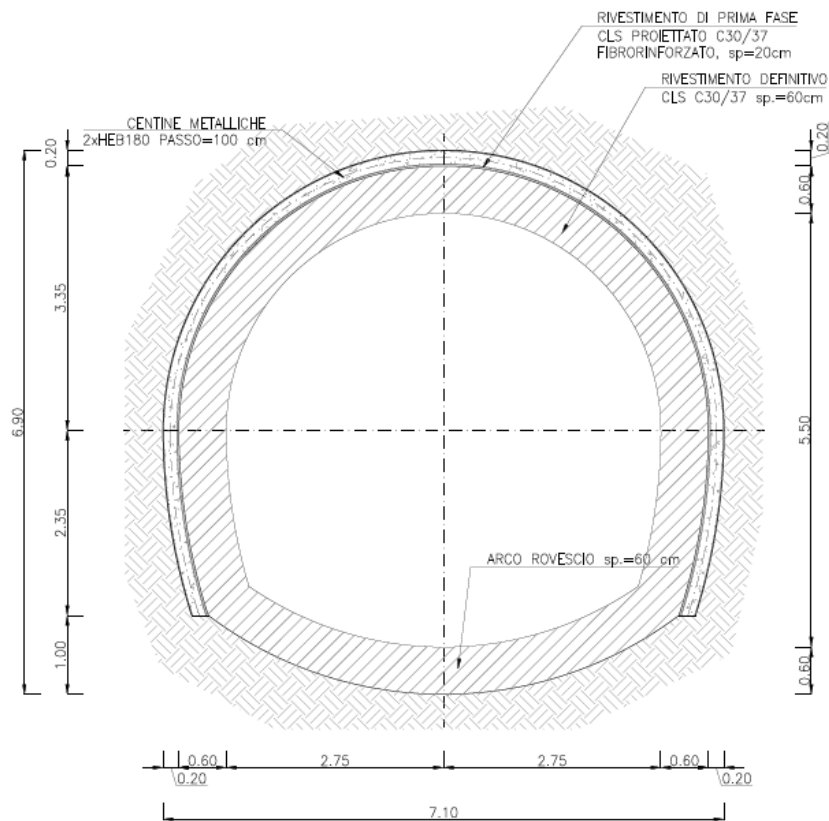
Sezione tipo GI-3: geometria del cavo e interventi di sostegno
